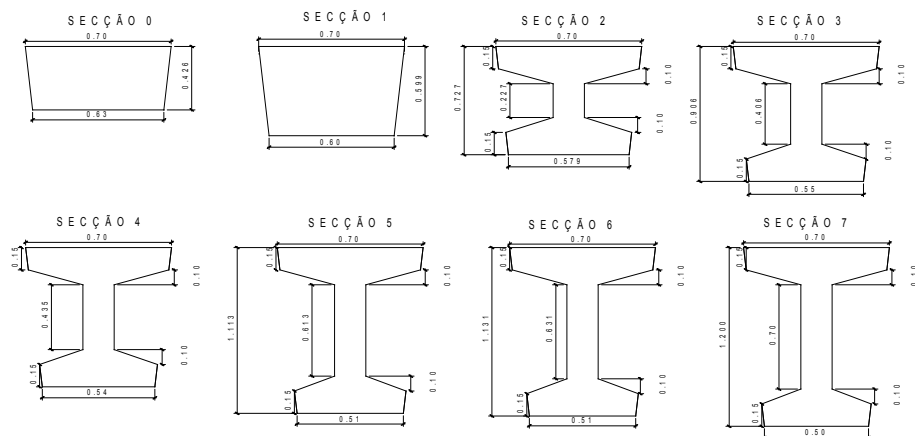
Secção transversal das divisões da carlinga (ponte sobre o rio Save).
